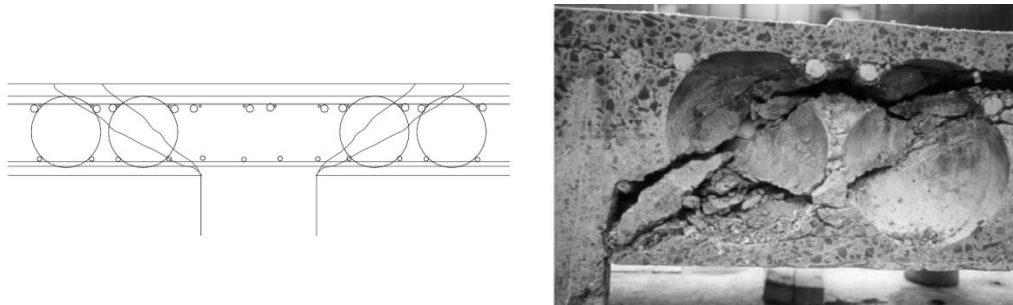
Padrão de fissuras das lajes ensaiadas por HELD (2002)
